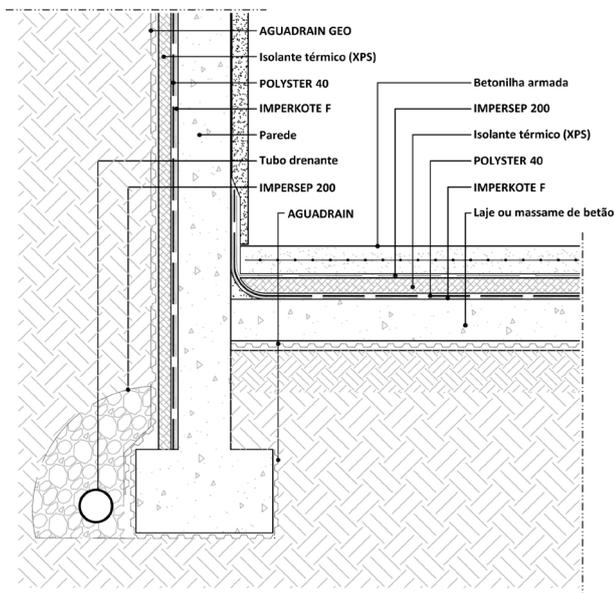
Aplicação dos revestimentos em paredes e pavimentos em contacto com o terreno
